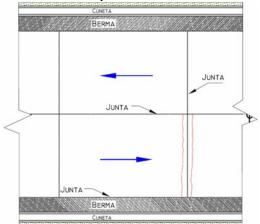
Vista en planta de grietas en los extremos de los pasadores.
